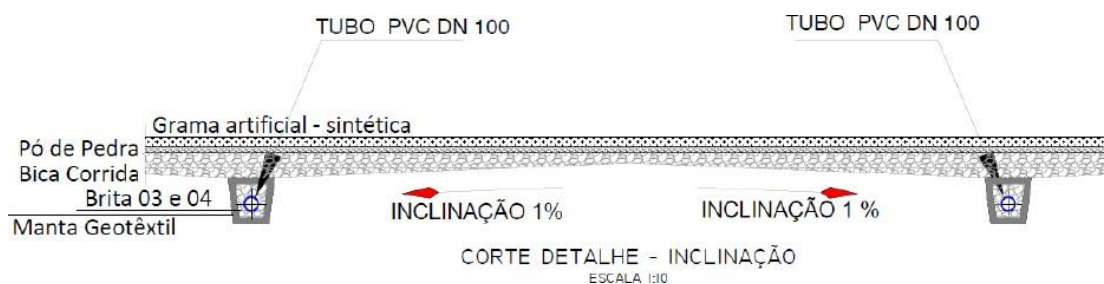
Detalhe da drenagem (Fonte: Autora/2022)
